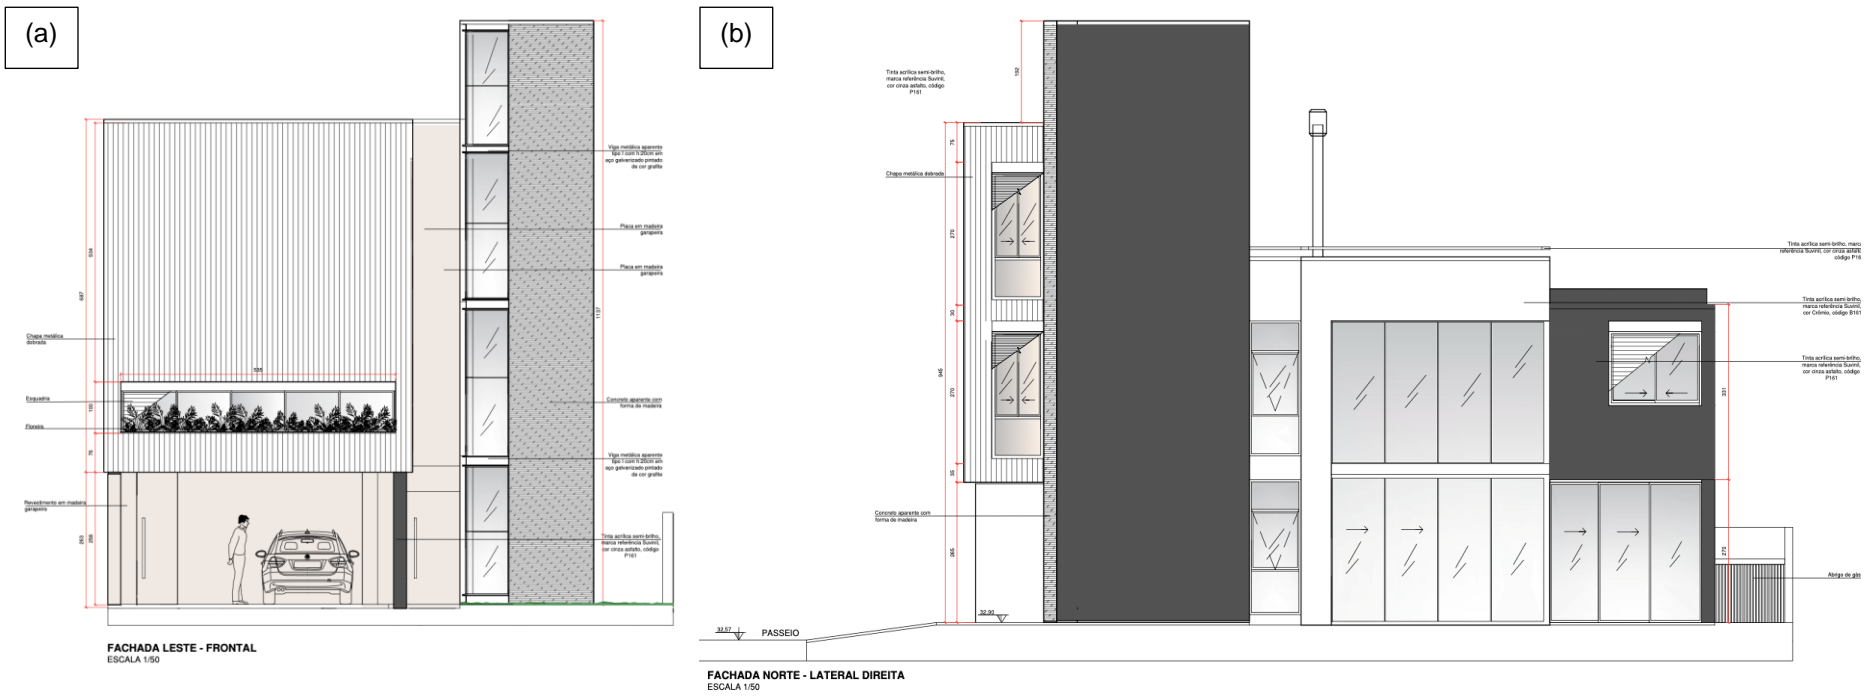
Em (a) Arquitetônica fachada leste – Frontal; e em (b) Arquitetônica fachada norte – Lateral Direita (Fonte: Projeto Arquitetônico)
